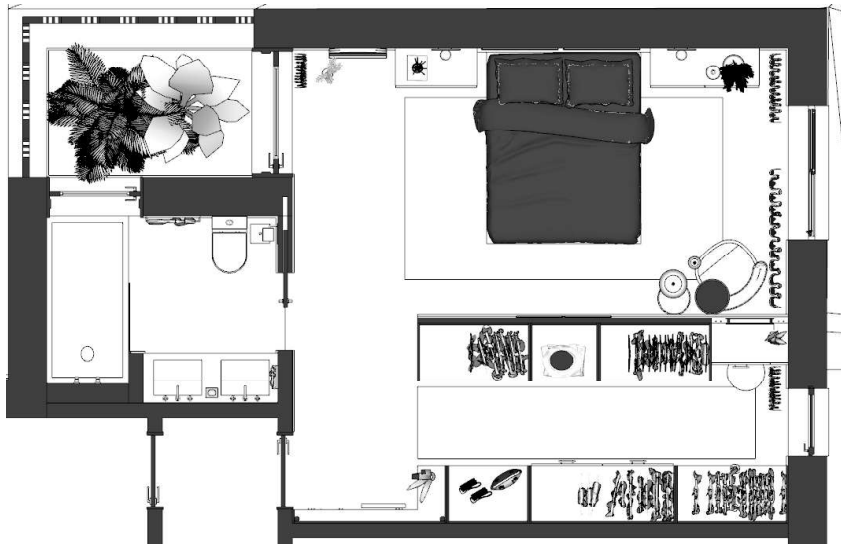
Planta s/escala, Suíte. *Fonte:* Autora.
